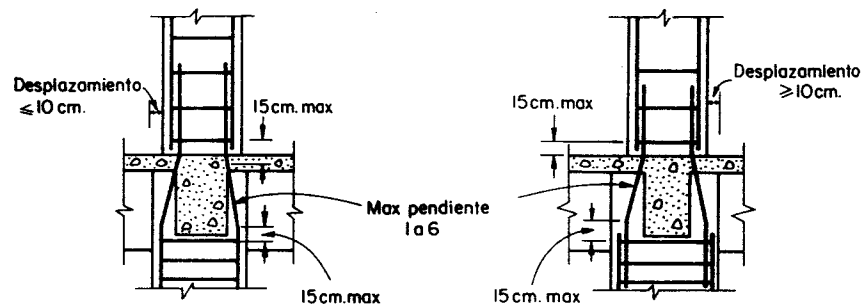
ARMADURA LONGITUDINAL EN COLUMNAS
